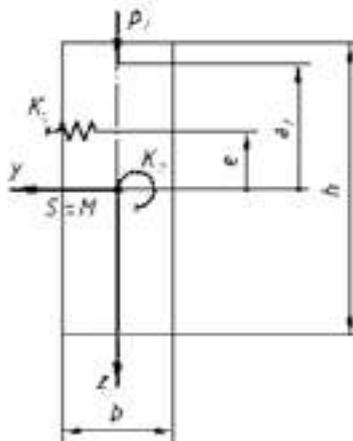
Bezeichnungen am Rechteckquerschnitt
